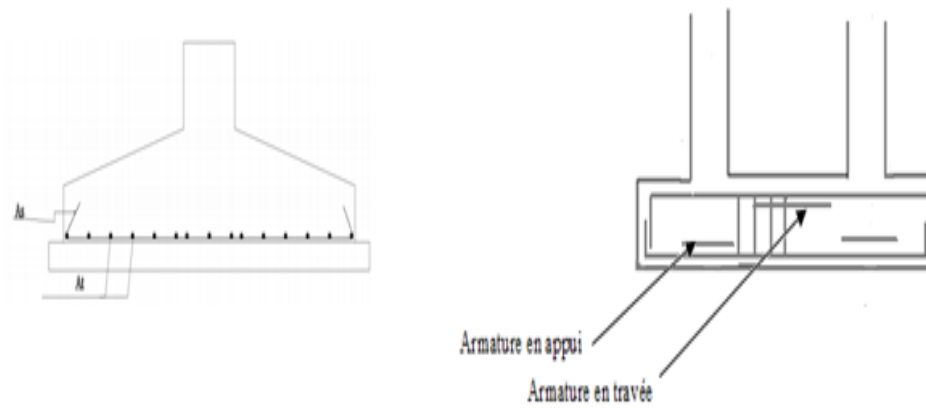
Coupe type ferrailage semelle filante (SF)
